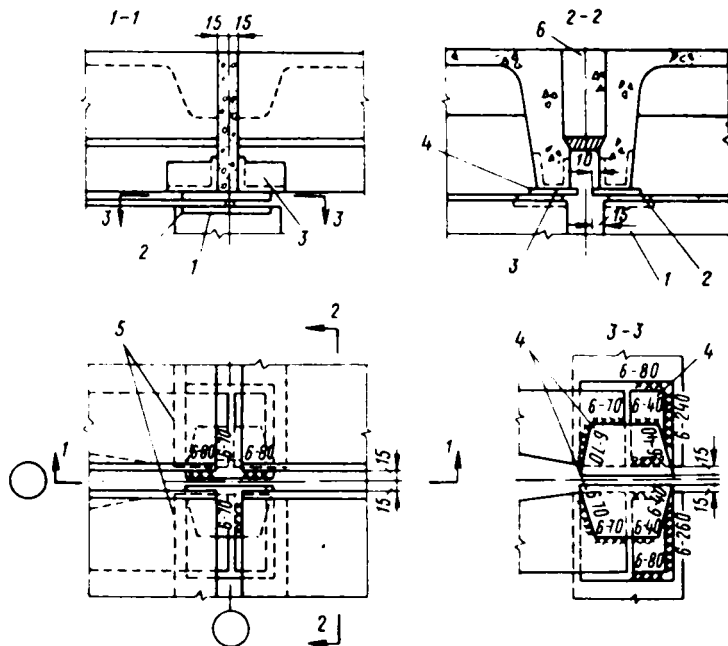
Детали крепления плит покрытий к фермам зданий с плоской кровлей по среднему ряду колонн (обозначения см. на рис. 2.18)
